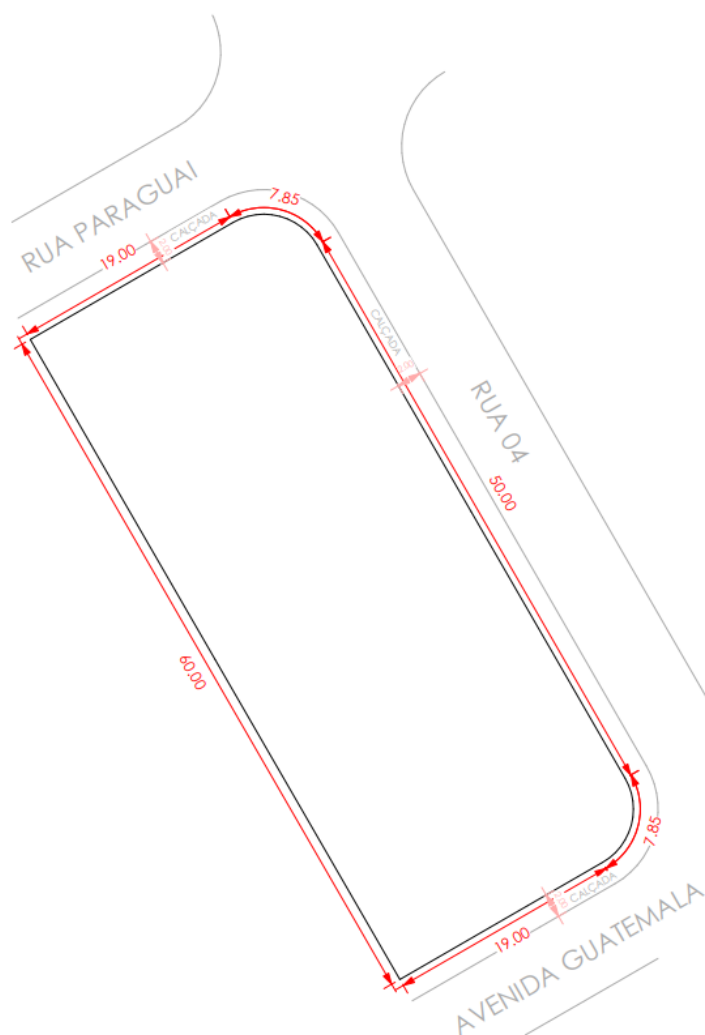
Terreno onde será implantado o empreendimento. Fonte: Projeto de unificação aprovado.
